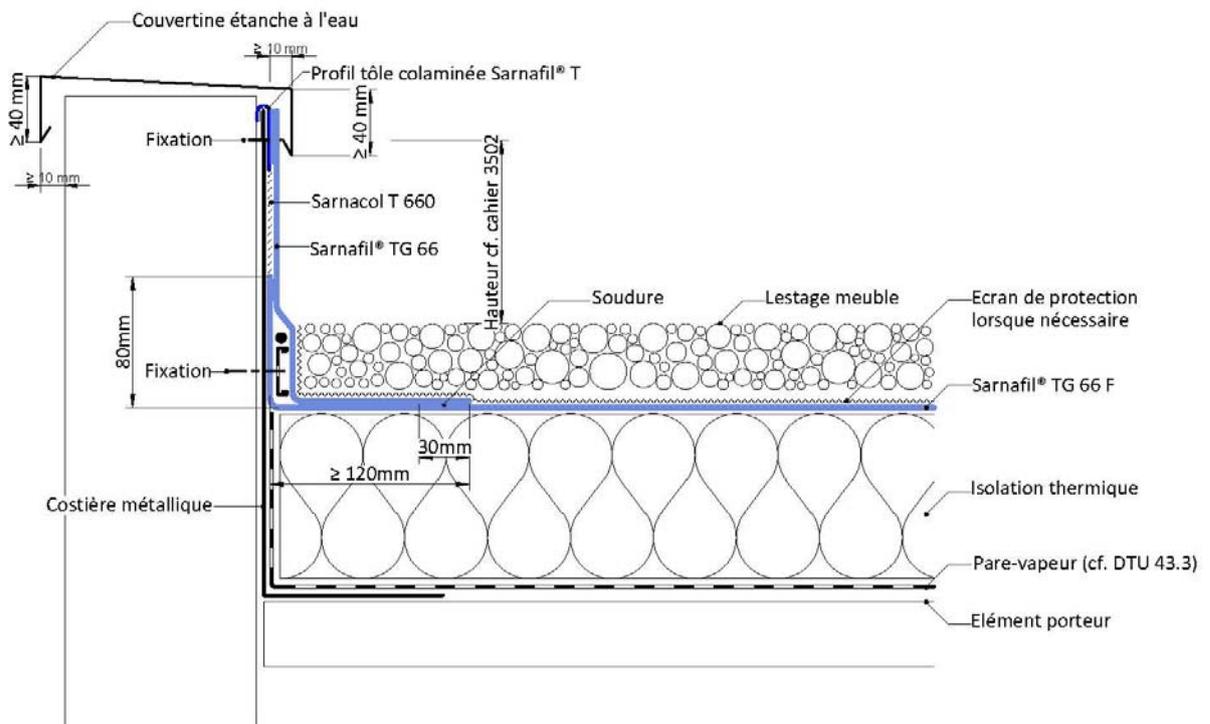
Relevé d'étanchéité avec profil de rive en tôle colaminée Sarnafil® T
